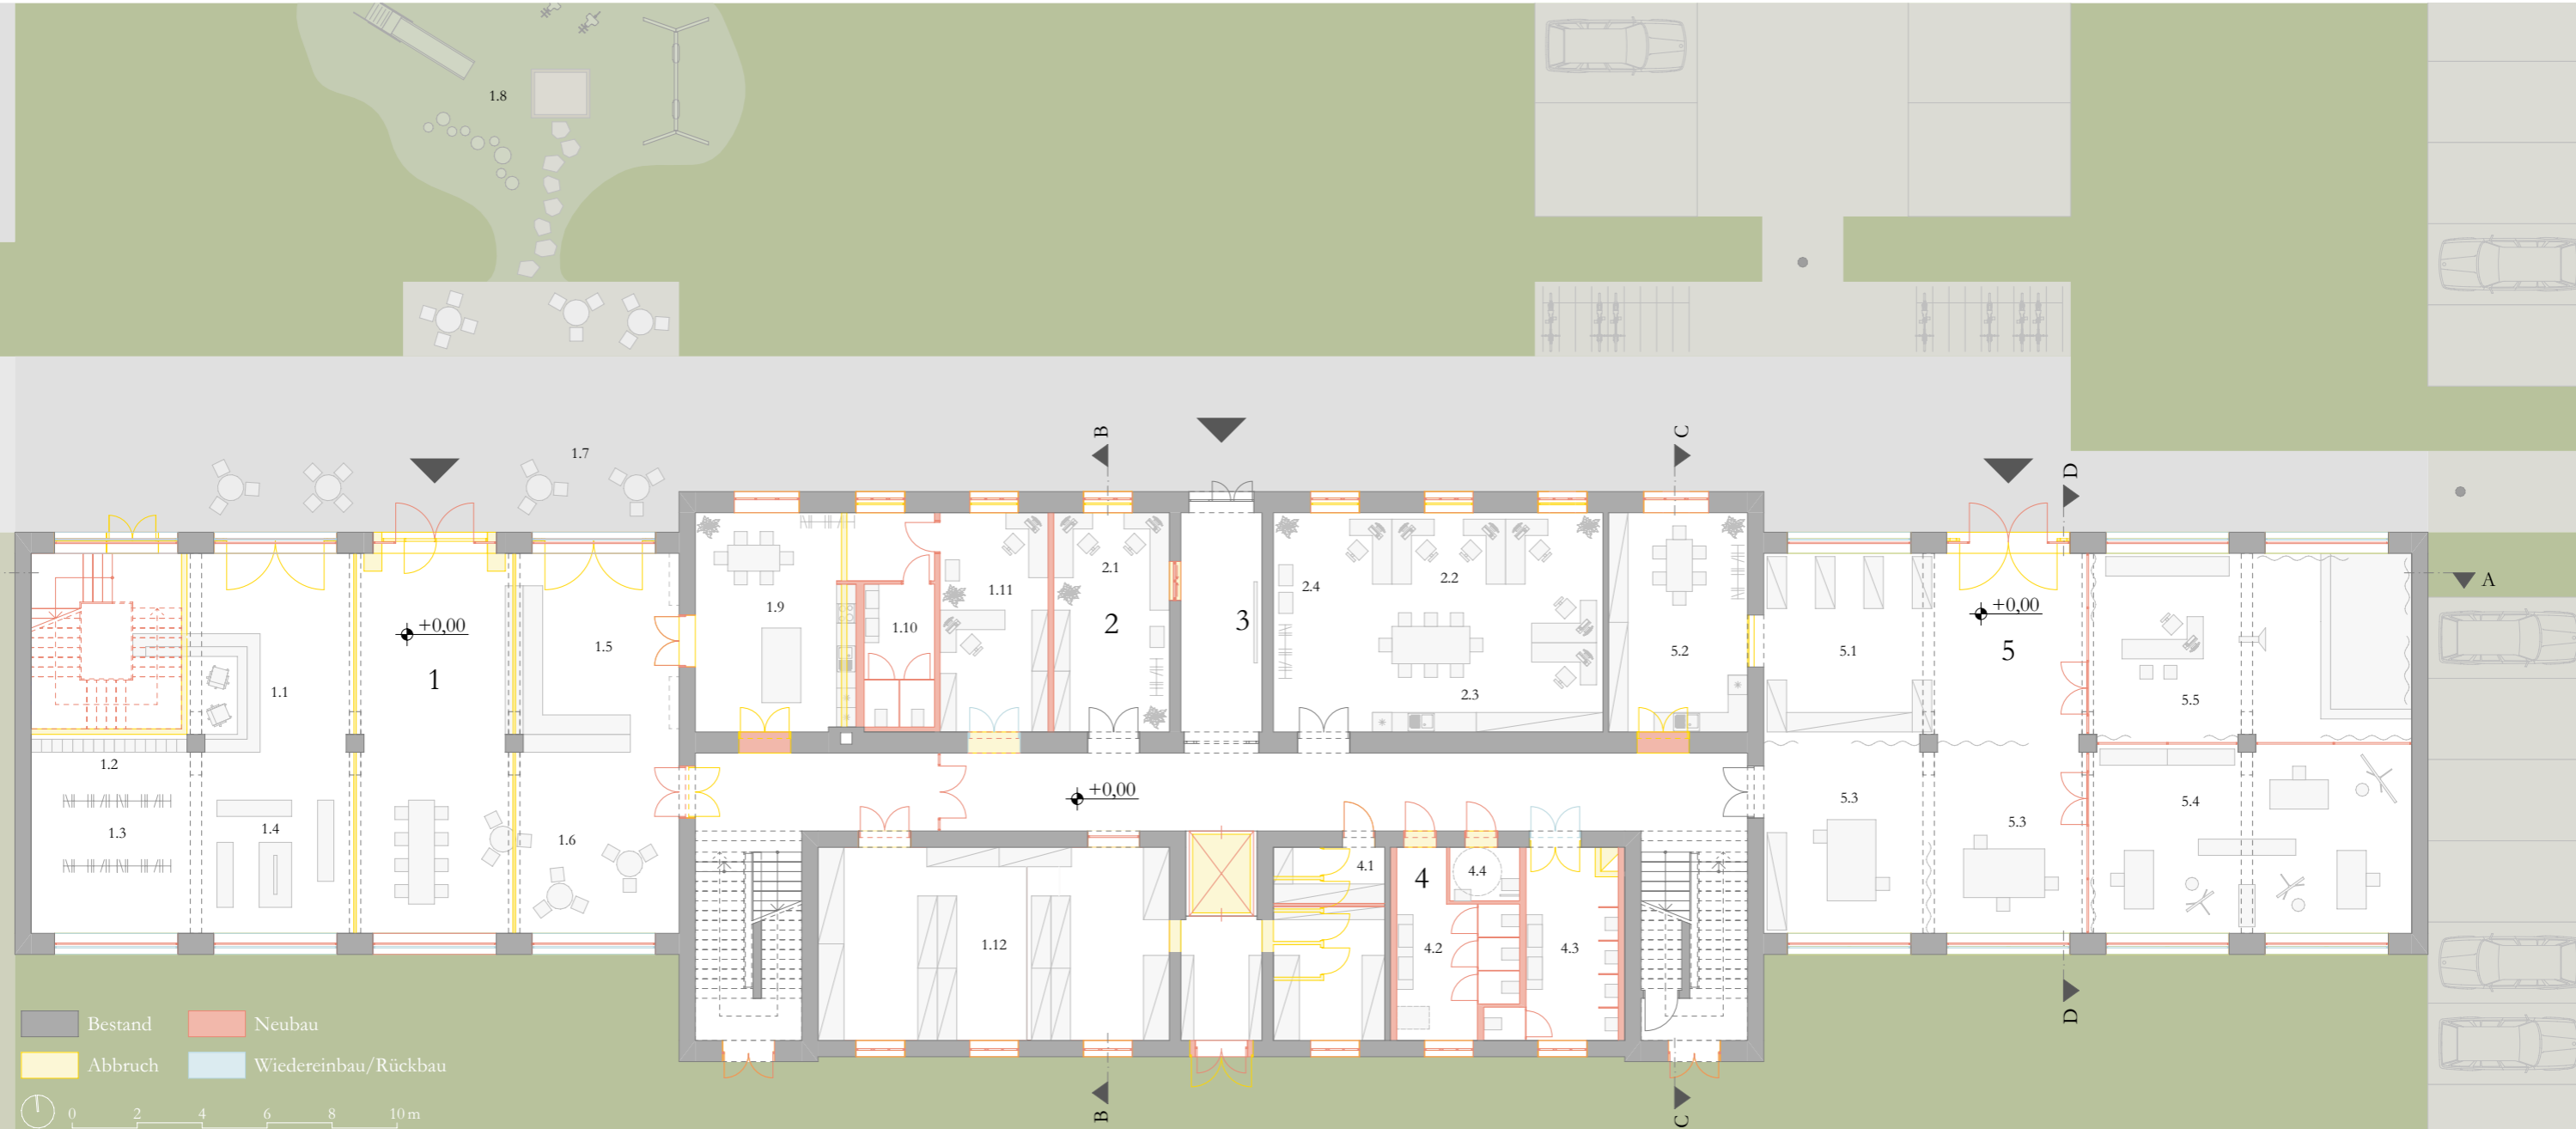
Grundriss Erdgeschoss (Konzept Gesamt) M 1:200
